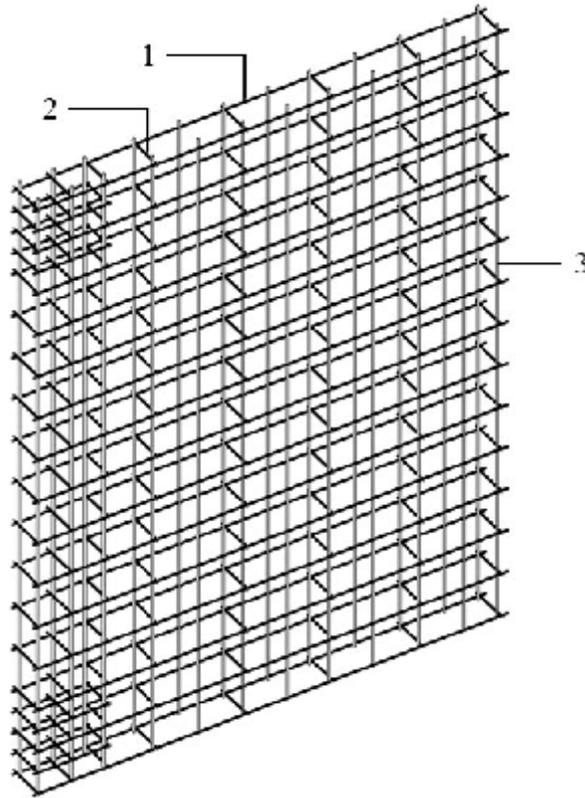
水平梯子形钢筋焊接网与竖向钢筋组成的钢筋笼构造示意
